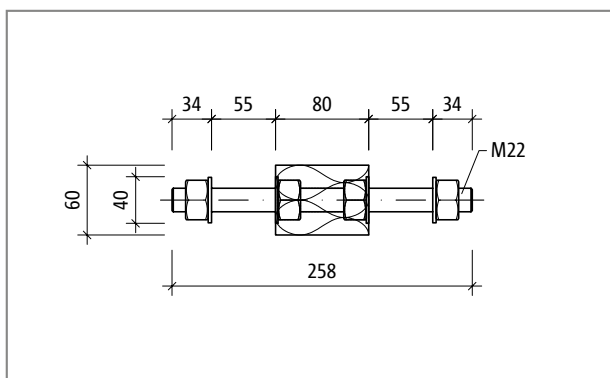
Schöck Isokorb® T type S-N-D22 : coupe du produit
